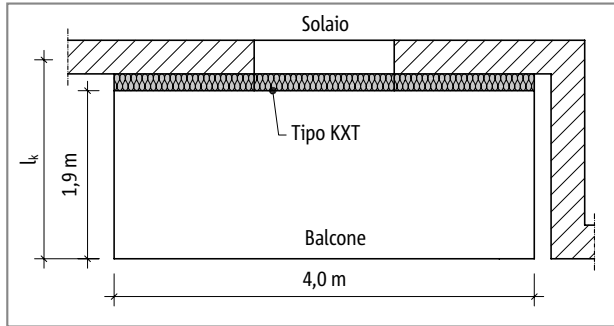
Schöck Isokorb® tipo KXT: pianta
